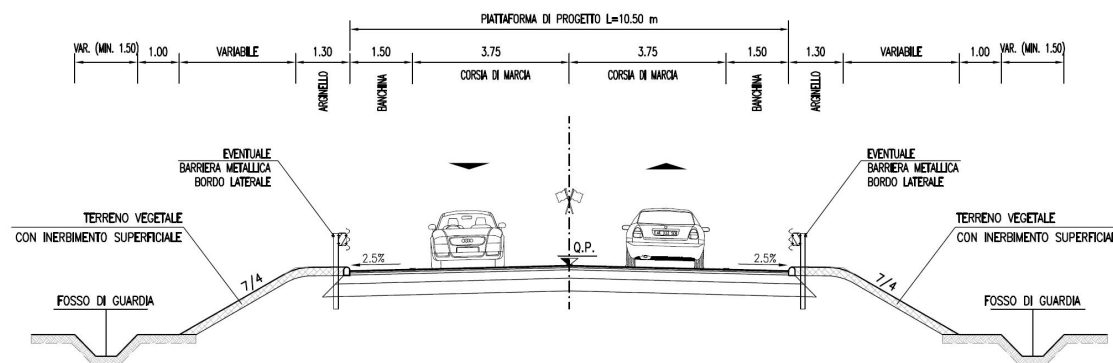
Sezione tipo rampa di svincolo bidirezionale
